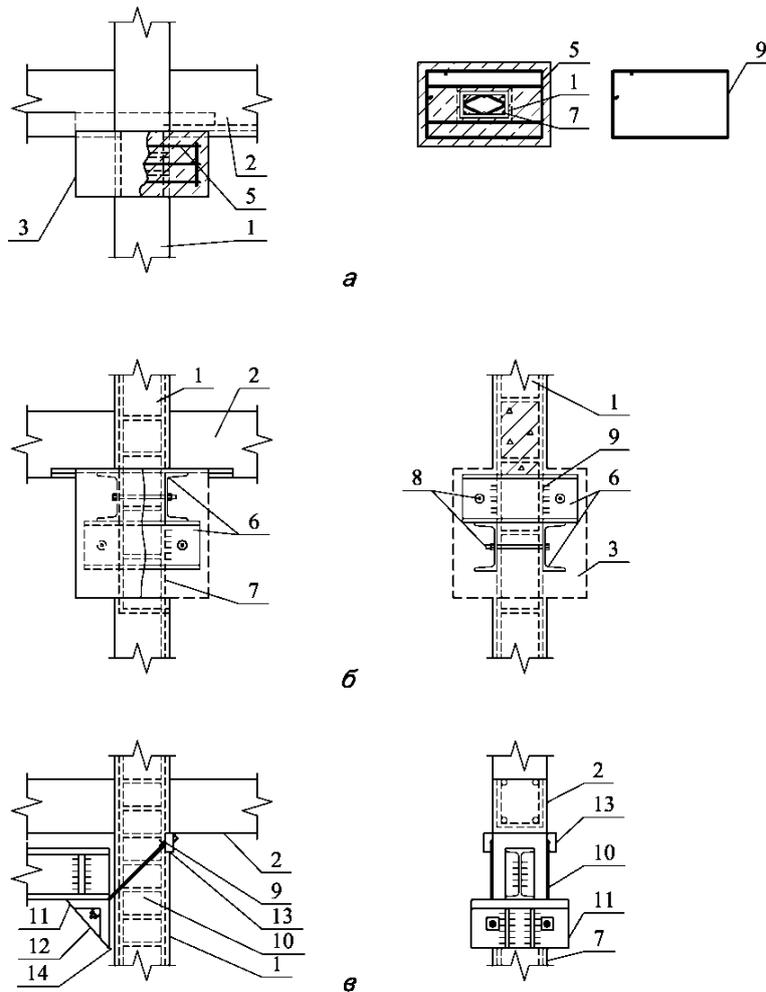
Устройство дополнительных опор на существующих колоннах: а – железобетонных; б – стальных обетонированных; в – стальных; 1 – колонна; 2 – ригель; 3 – бетон хомута; 4 – коническая шайба; 5 – поперечная арматура хомута; 6 – швеллер; 7 – оголенная арматура колонны; 8 – стяжной болт; 9 – сварной шов; 10 – тяж; 11 – опорный уголок; 12 – ребра жесткости; 13 – пластина; 14 – пластина с рифлёной поверхностью
